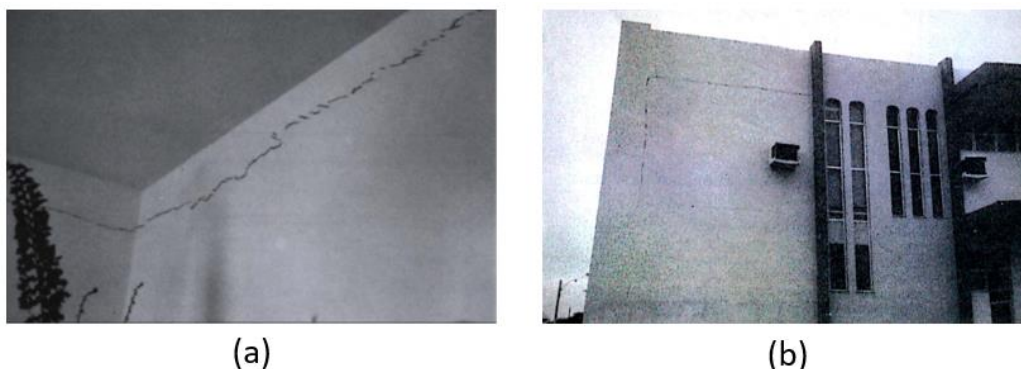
Fissura de contração térmica e retração por secagem: (a) causada por movimentação da laje; (b) causada por retração da alvenaria (THOMAZ, 2020)
